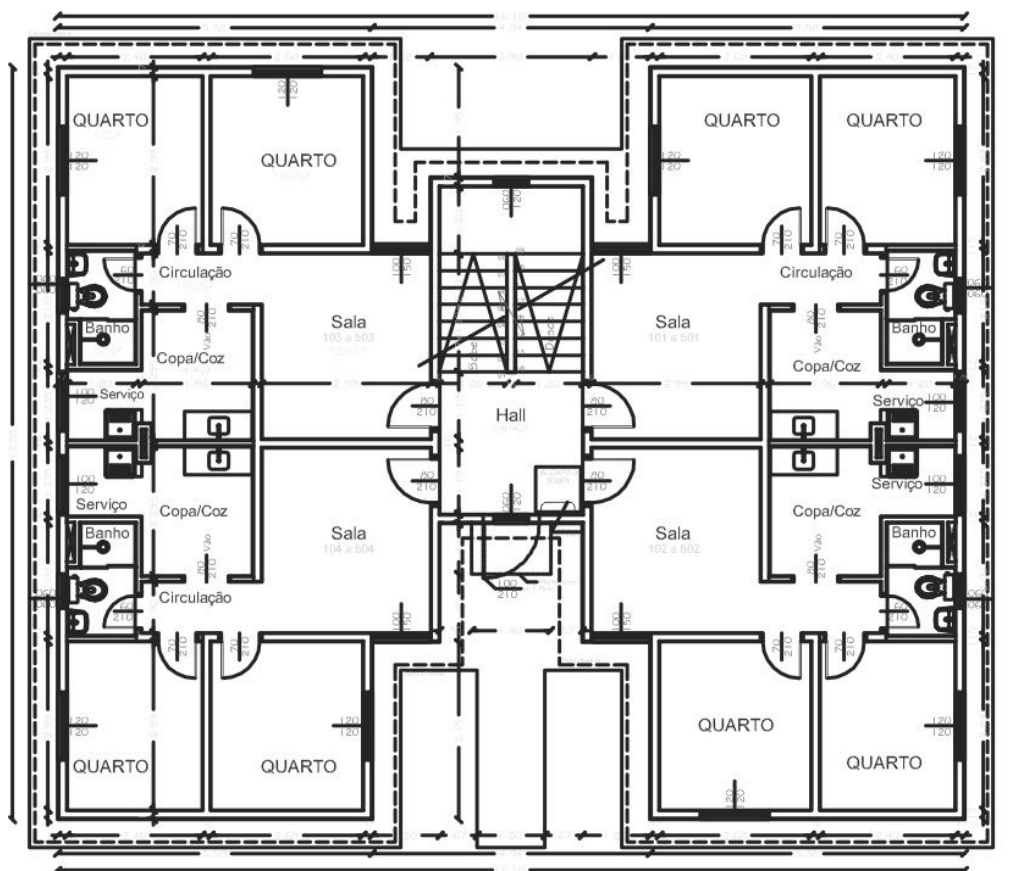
Pavimento tipo do Vivendas da Serra III (VALOR e PERANTONI, s.d.)
